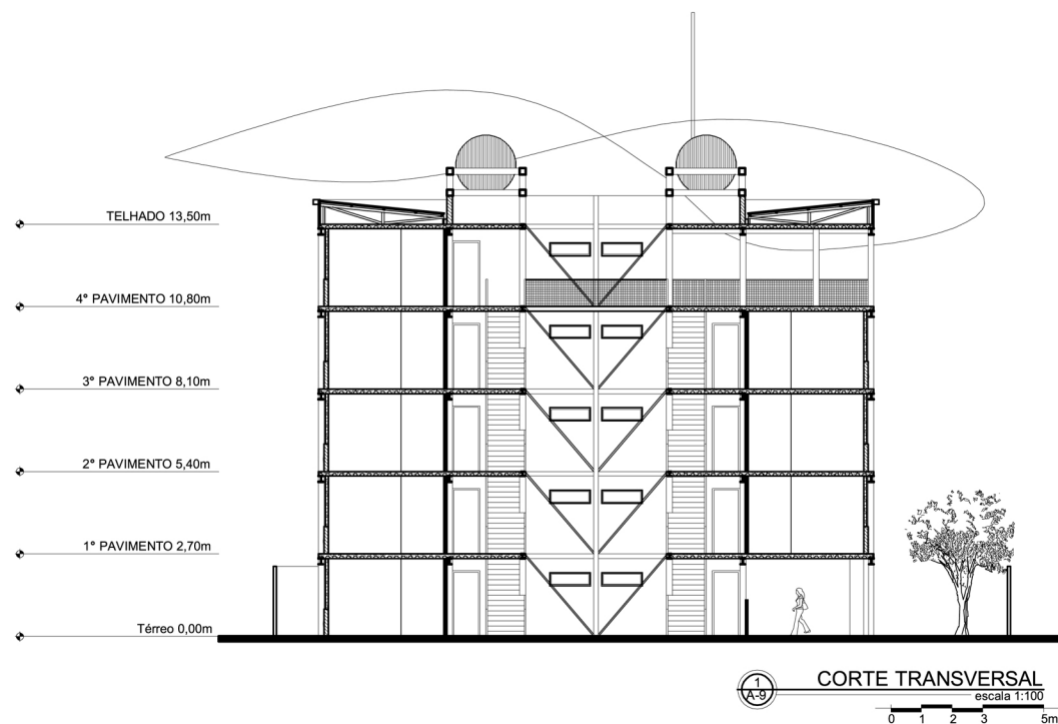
Corte transversal. Fonte: Arquivo do autor
